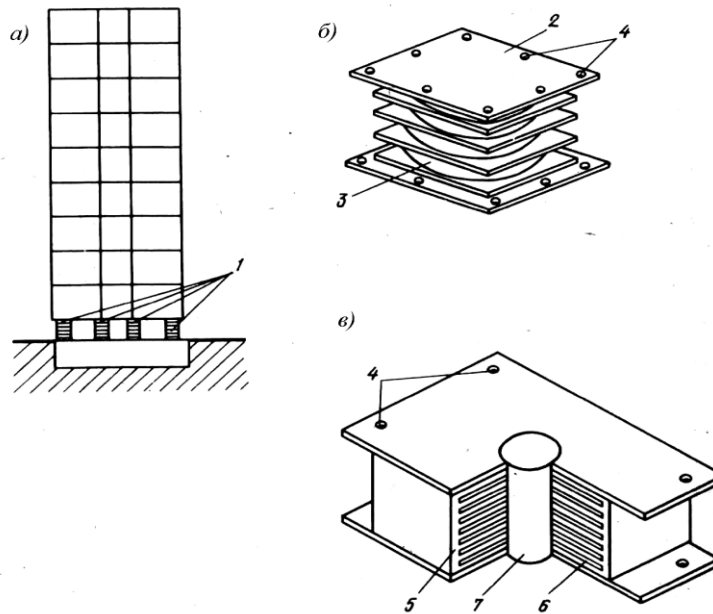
Сейсмоизоляция здания с помощью резинометаллических опор: *а* – схема установки опоры; *б* – схема конструкции опоры GAPEC; *в* – схема конструкции опоры, разработанной в Новой Зеландии; 1 – опора; 2 – стальная плита; 3 – слой неопрена; 4 – отверстия для анкерных болтов; 5 – резина; 6 – сталь; 7 – свинец
